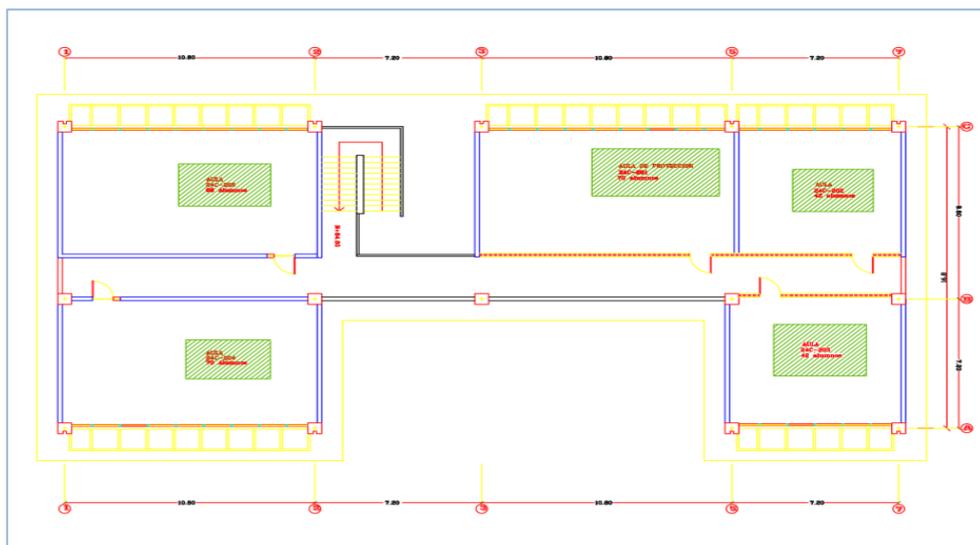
Planos Bloque C Planta Alta – Zona 1
